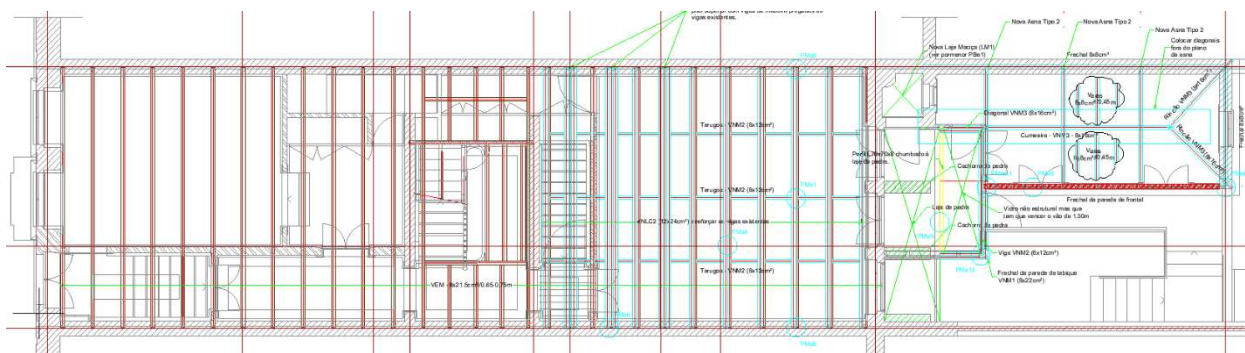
Projeto estrutural do piso 1 (Edifício 1)
